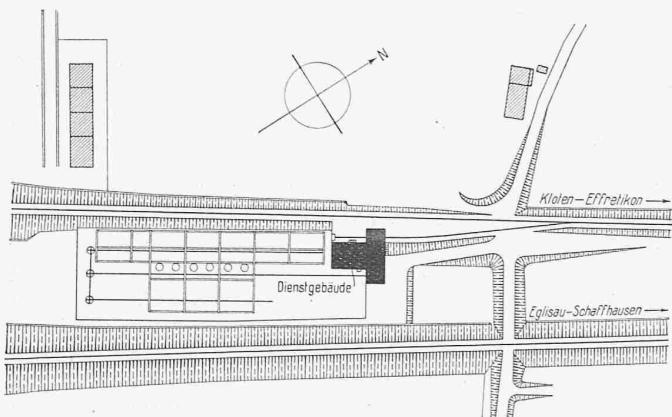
Lageplan des Freiluft-Unterwerkes Seebach. — Maßstab 1:3000.
